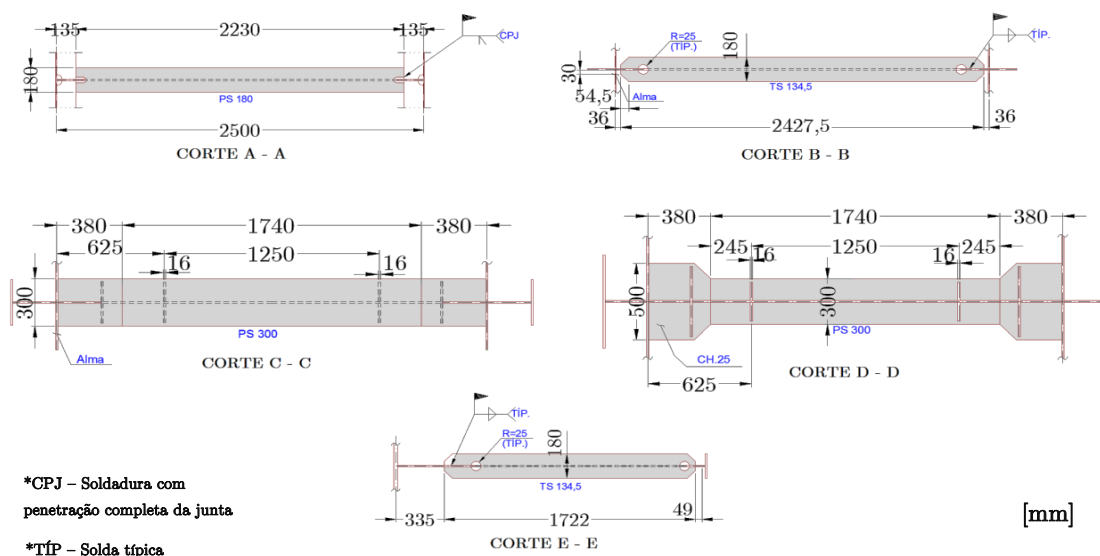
Pormenor da estrutura metálica nas zonas dos apoios
